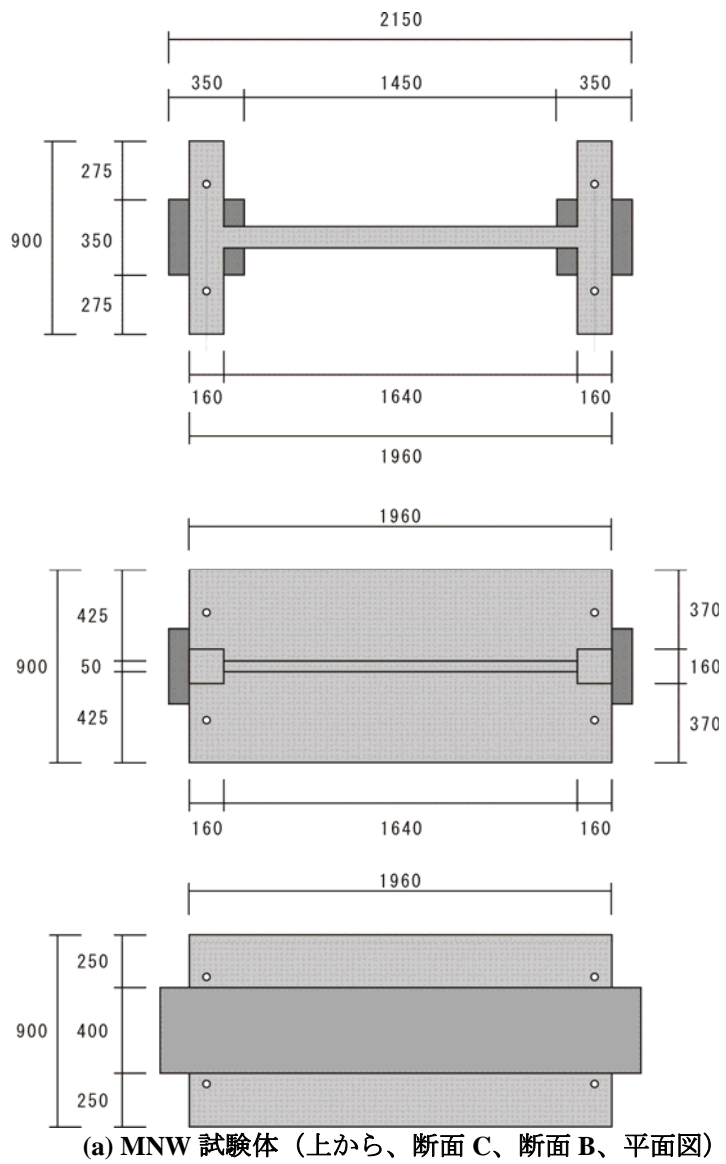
各試験体の断面図及び平面図 (単位 : mm)
